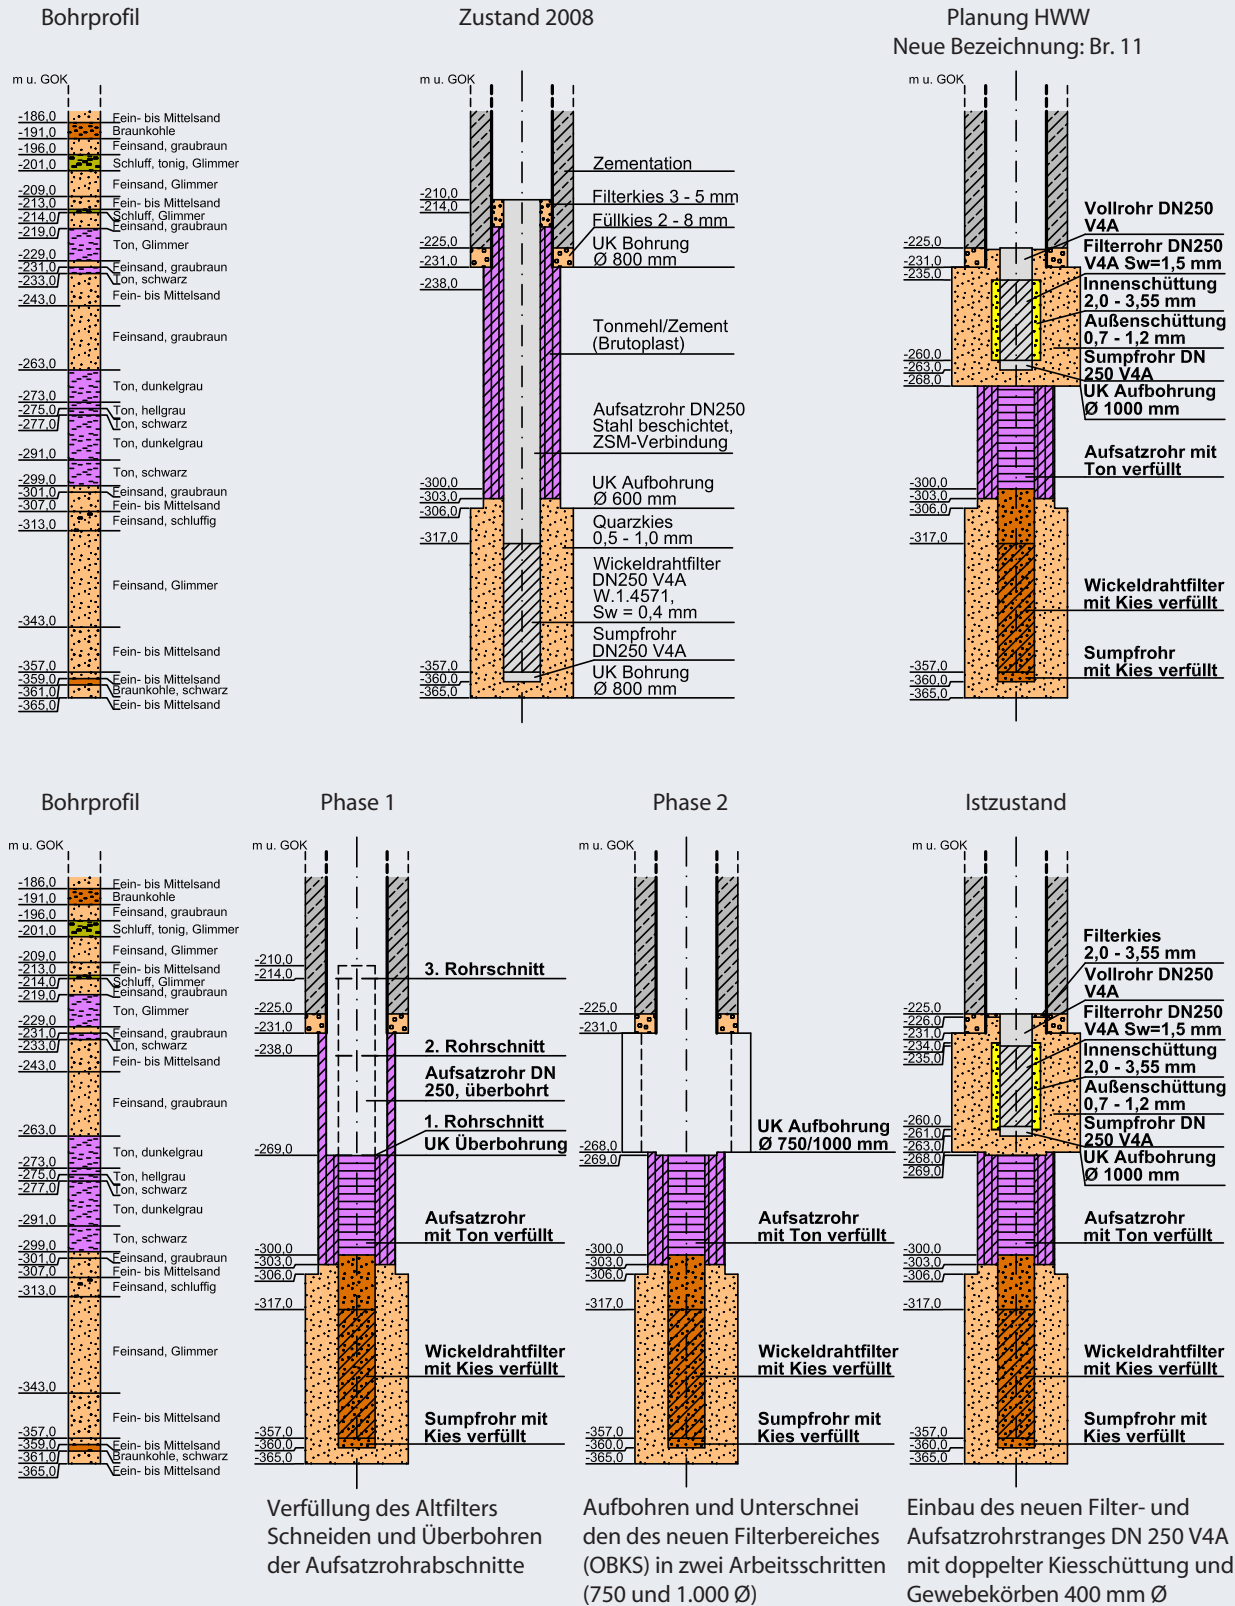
Detailansicht Tiefbrunnen 7/11: Planung und Ausführung
